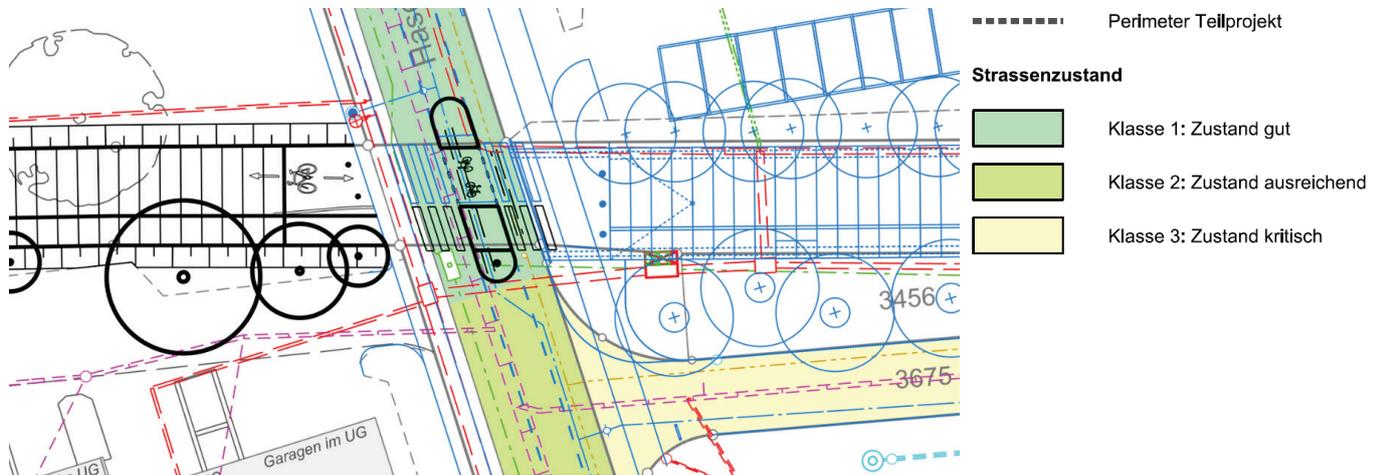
Ausschnitt Bestvariante Abschnitt Querung Hasenmattstrasse (siehe auch Massnahmenplan Werkleitungen, Anhang 3)
